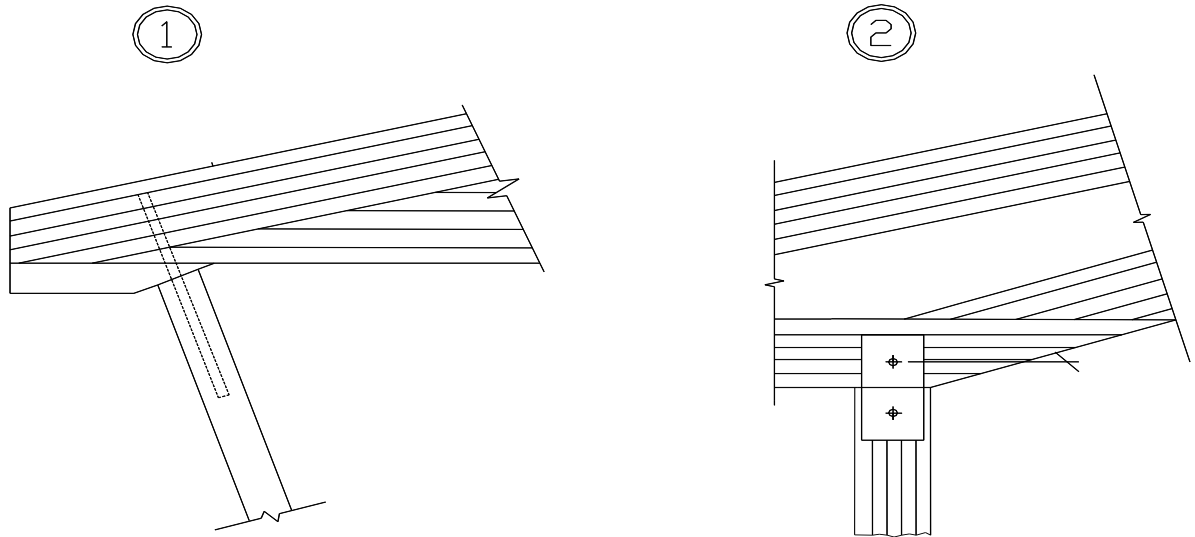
Схема крепления карнизного узла: 1) крепление подкоса с ригелем, 2) крепления стойки с ригелем.
